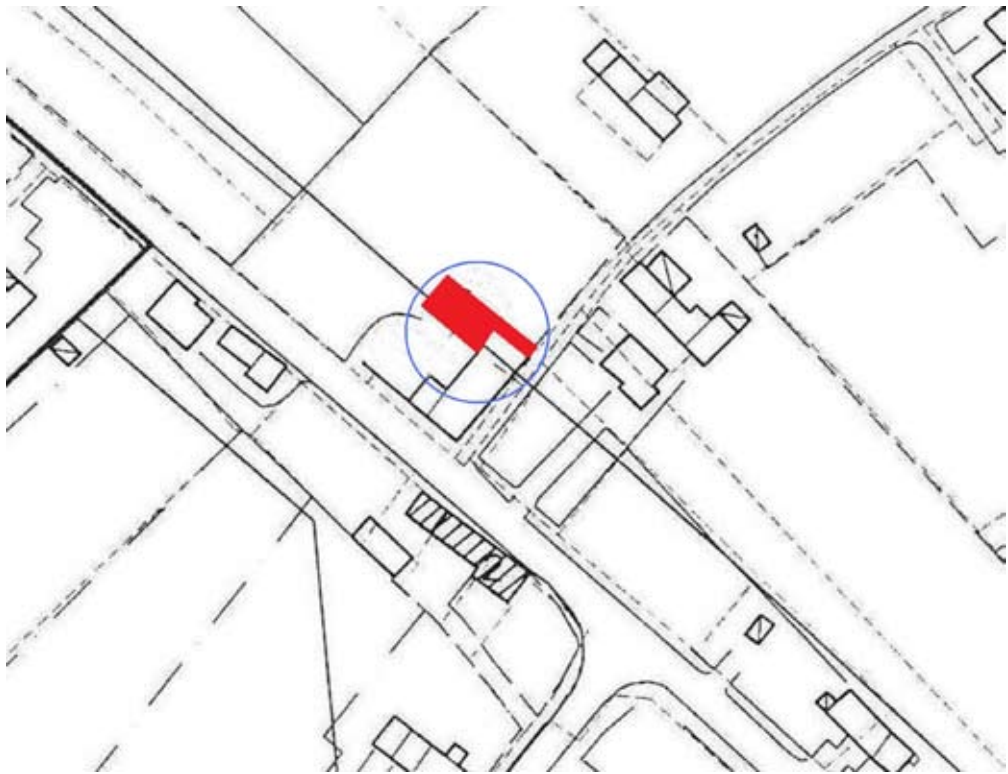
Planimetria generale, con evidenziata l'area di intervento.
